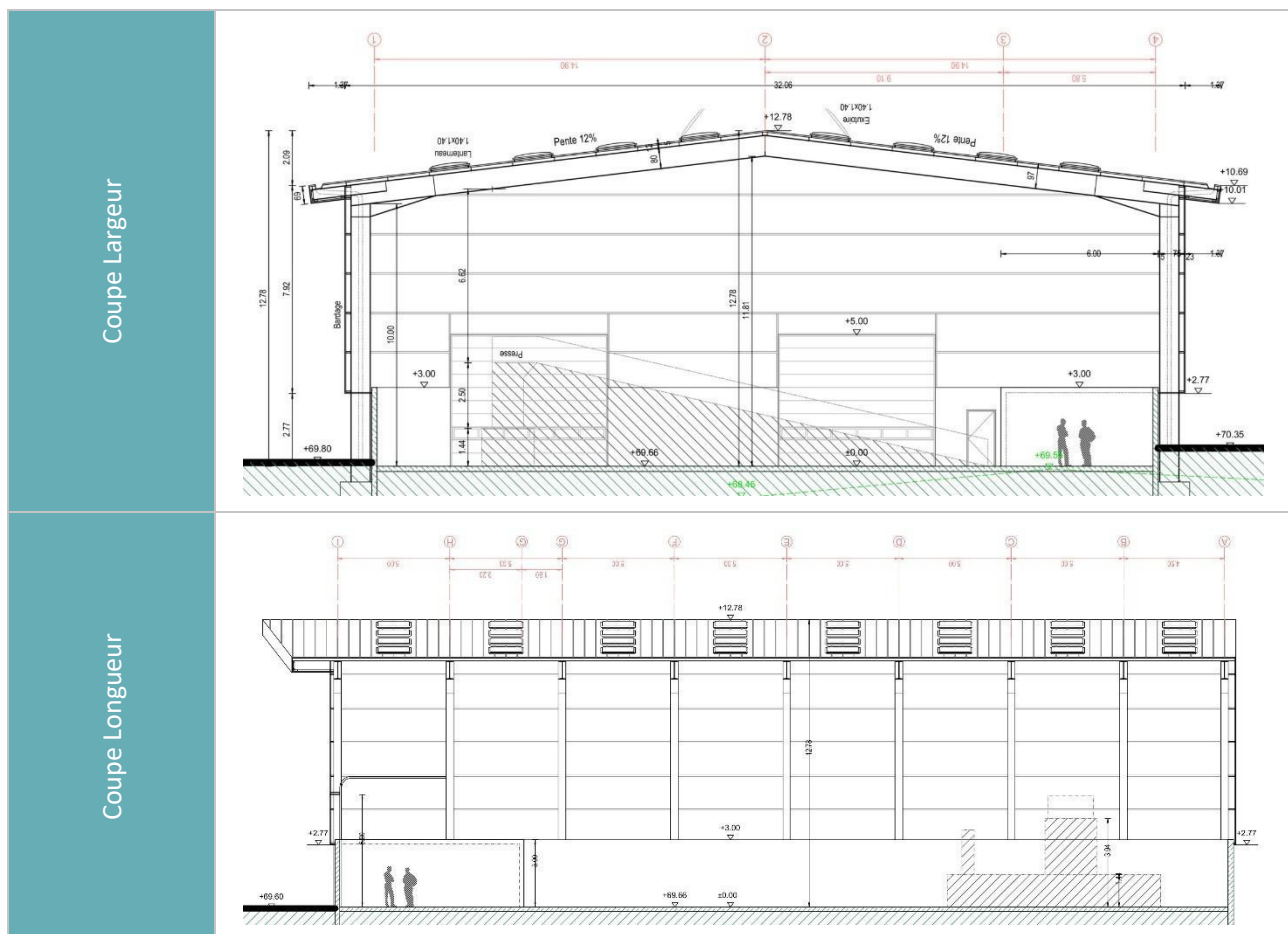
Miniatures des plans de coupe du bâtiment presse (plans PC)
